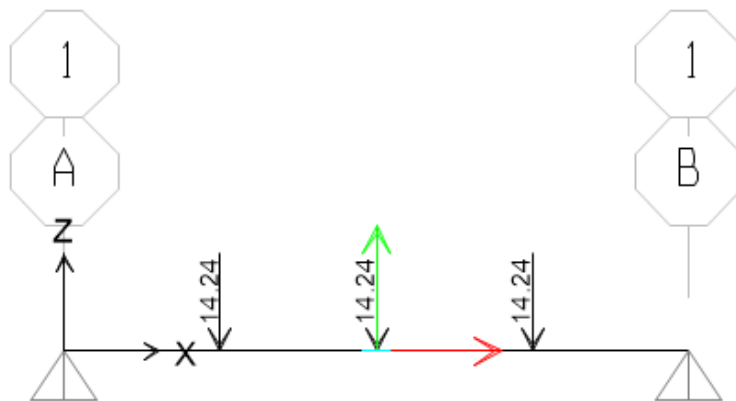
Análisis Estructural Viga Principal (Simplemente Apoyada)
